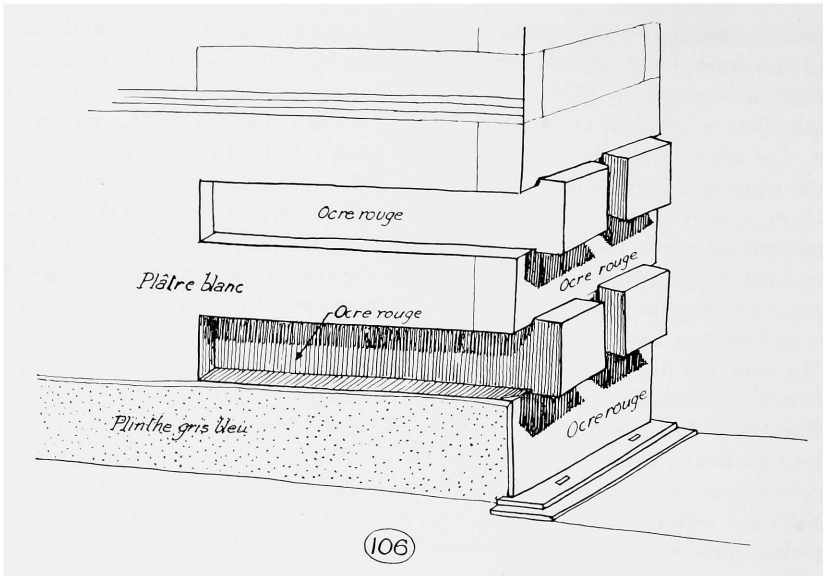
Cour 106. Pied-droit ouest de la porte 112-106.
